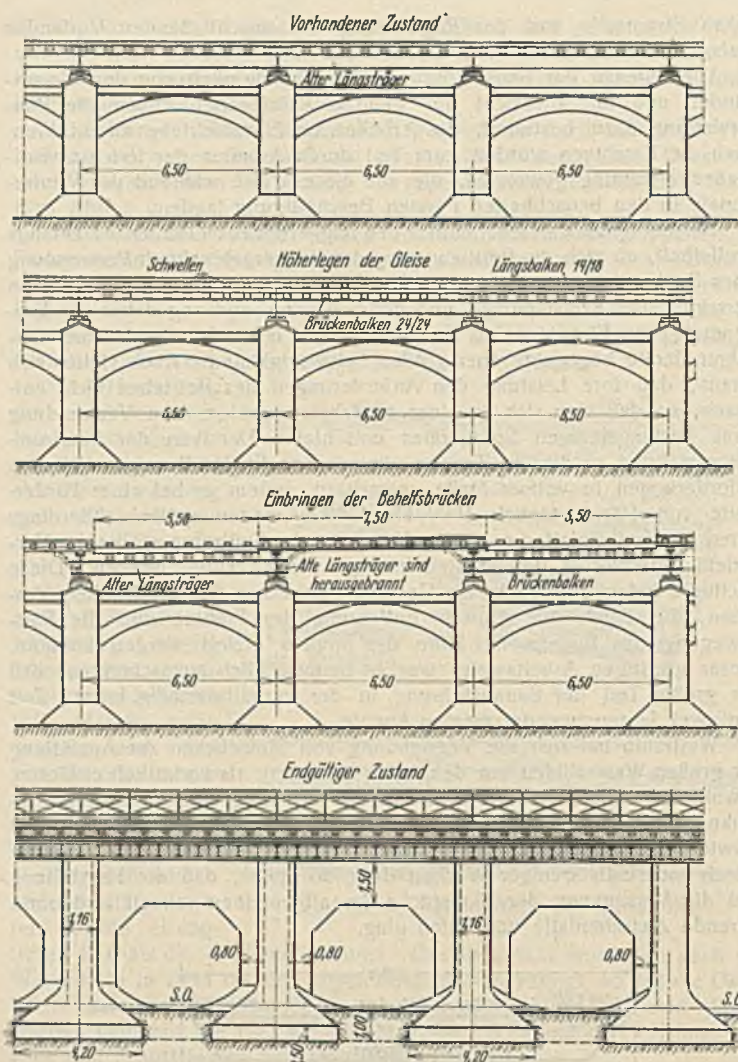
Darstellung des Neubaus unter Durchführung des Eisenbahnbetriebes.
